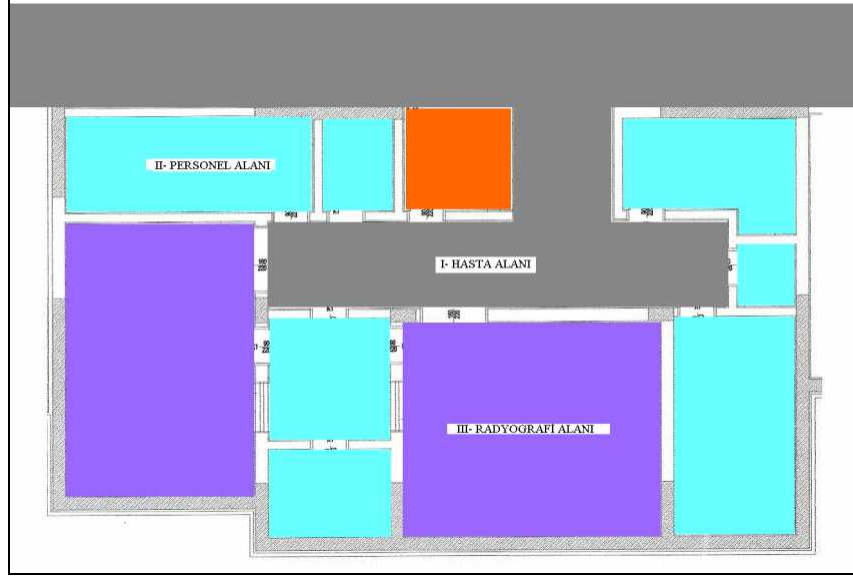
(c). 1. Kat Planı (+4.20 kotu)
